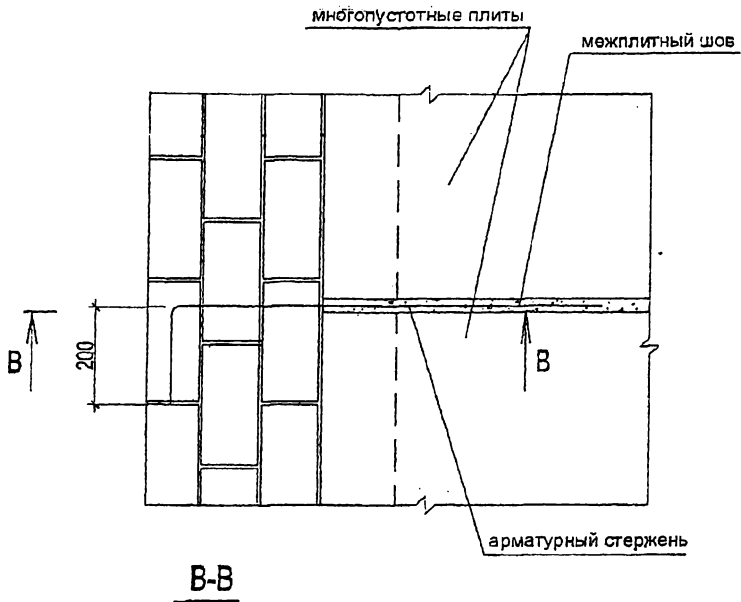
Схема опирания плит безопалубочного формирования на кирпичную кладку без устройства монолитного пояса
